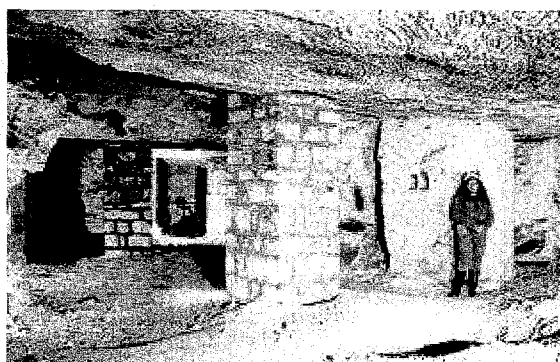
Piliers maçonnés (carrière de pierre à bâtir, Aisne)
